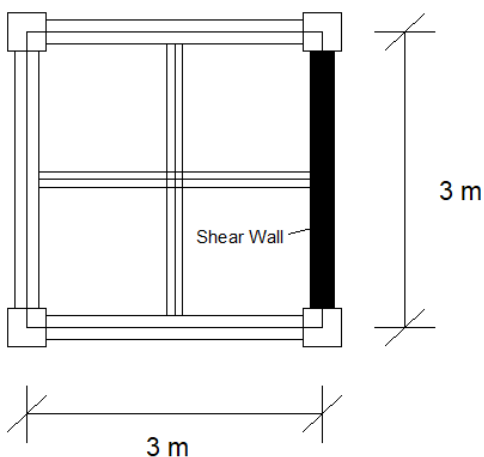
Denah Plat Lantai Atas (Tipe 3)
